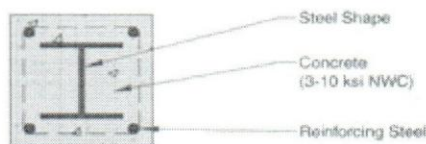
Columna mixta con perfil de acero embebido en concreto¹²
